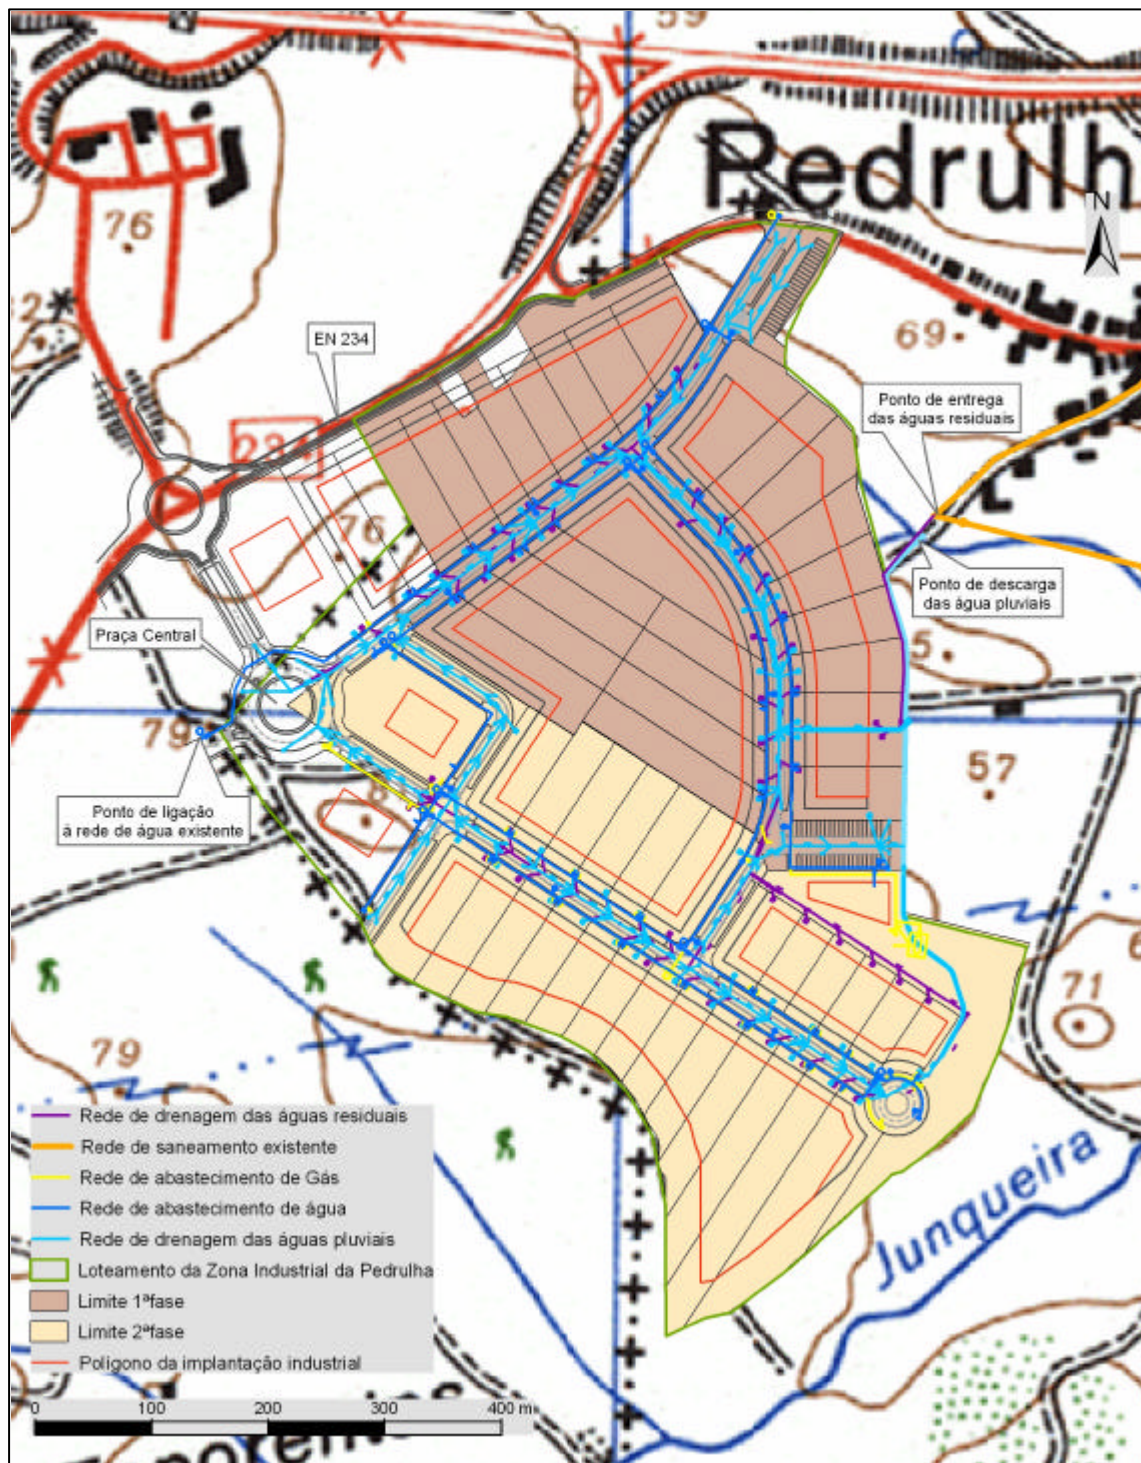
Rede de infra-estruturas de abastecimento e drenagem.
